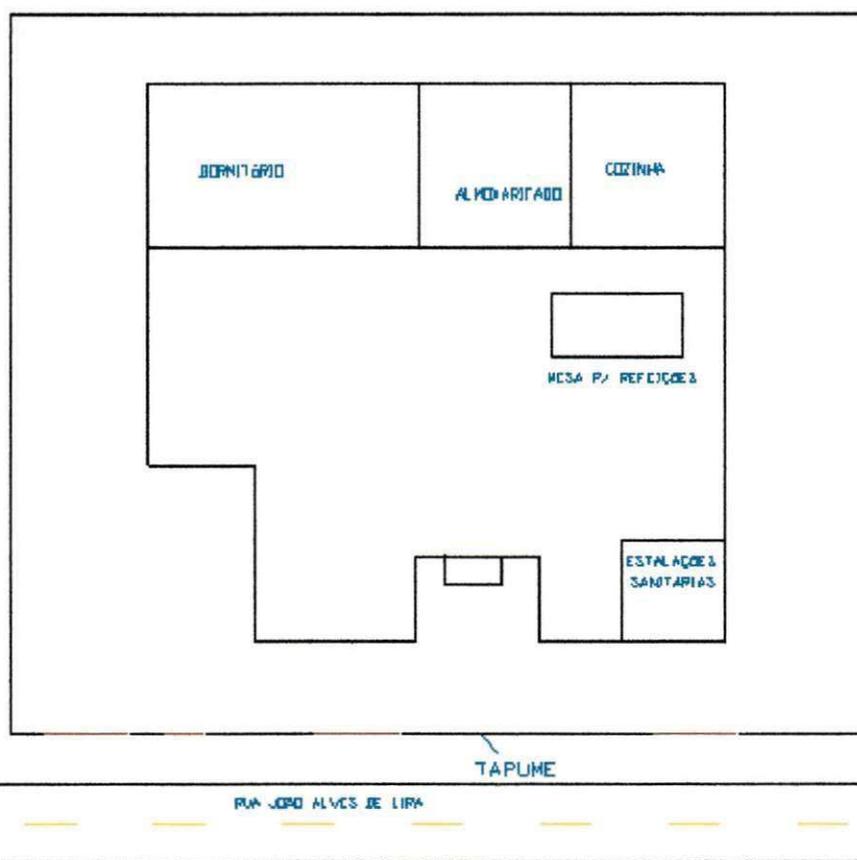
Esboço do canteiro de obras - 1ª Laje.
